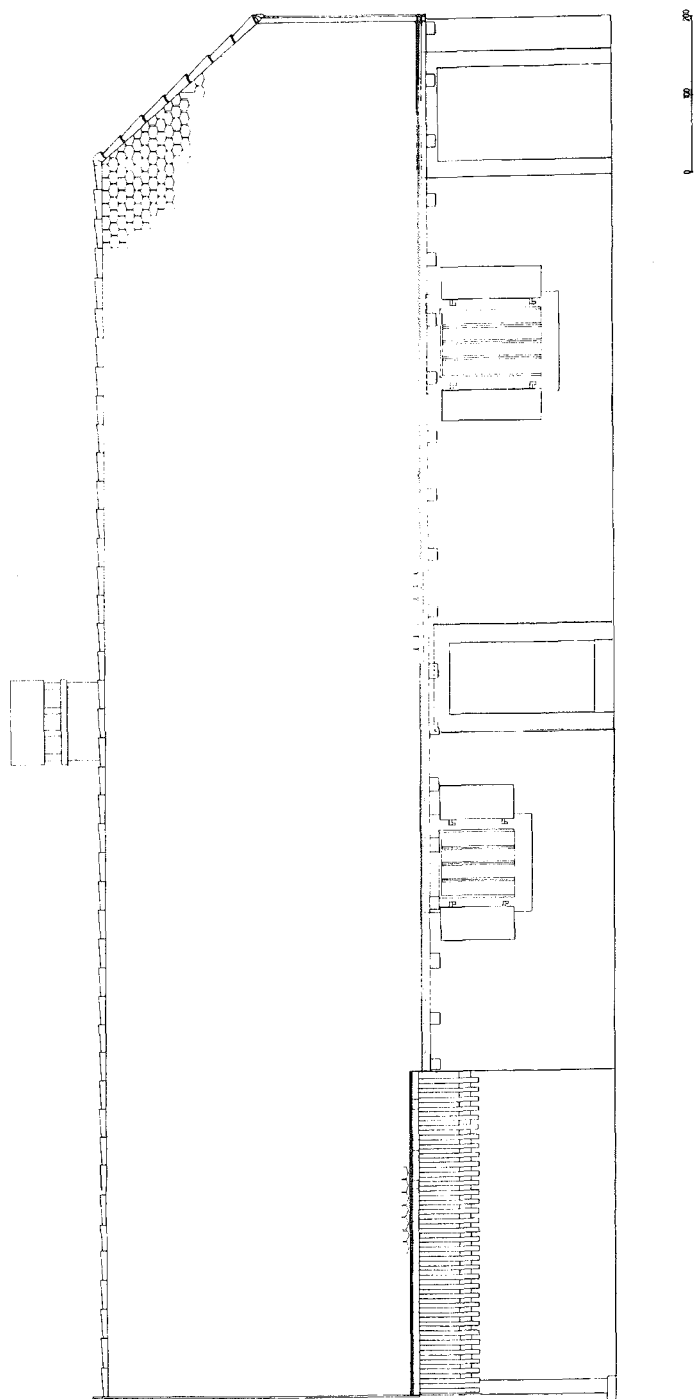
Façade sud : bûcher, entrée du four et du pressoir.
